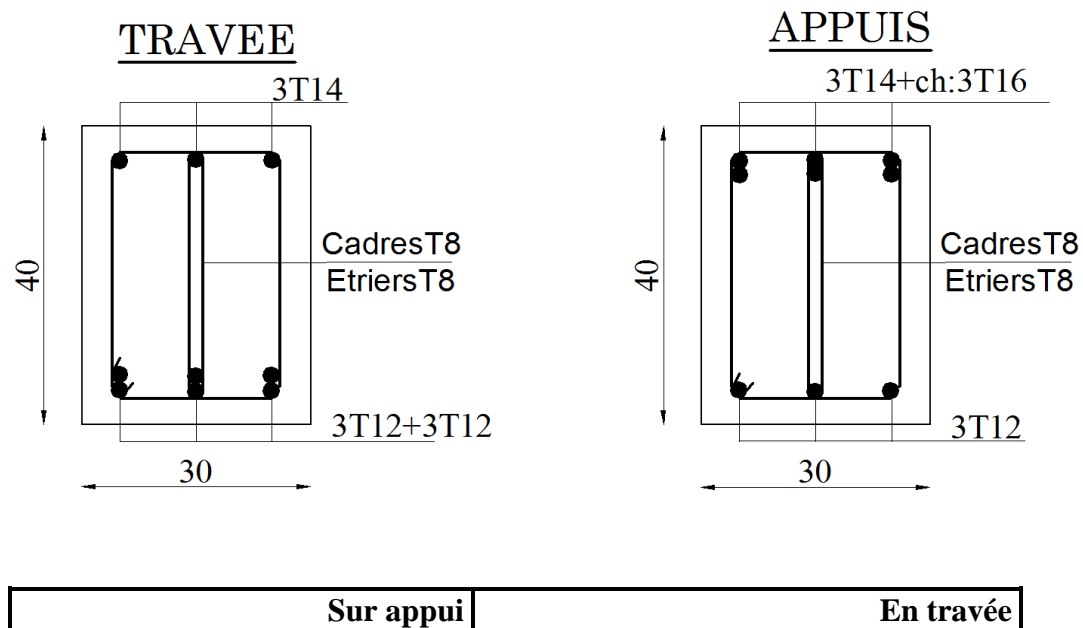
Ferrailage de la poutre secondaire sous voile
